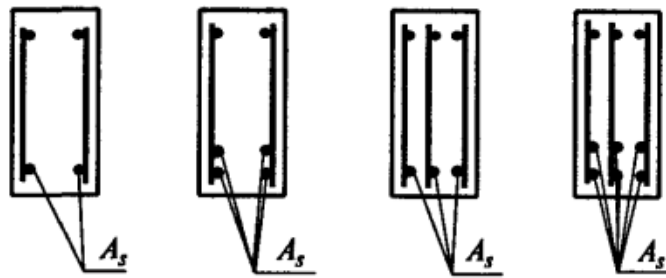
Варианты армирования балки — к примеру 7.4
